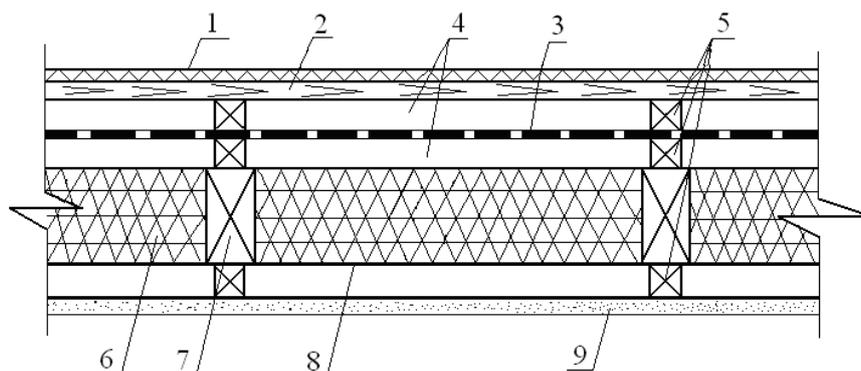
Конструкция скатной крыши с теплоизоляционными плитами или матами в два слоя и вентилируемой воздушной прослойкой:
